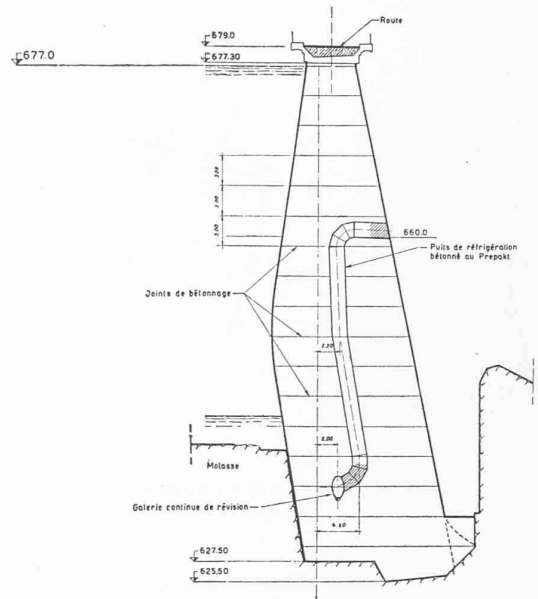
Coupe latérale rive droite du barrage. Echelle 1 : 700.
